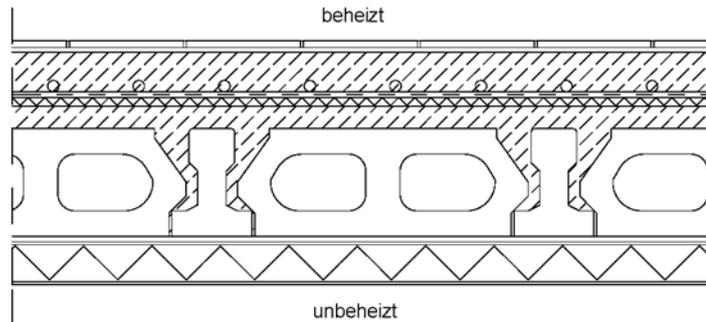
Rippendecke mit dem Fußbodenaufbau, Sanierung
